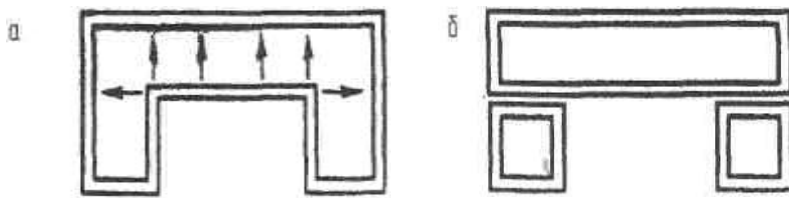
Схема розрізки будівлі із складною конфігурацією в плані на самостійні відсіки: а — не рекомендоване вирішення; б — рекомендоване вирішення
